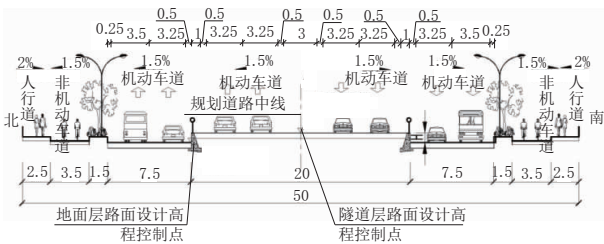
地下通道接地点处横断面设计示意图(2-2剖面)(单位:m)
